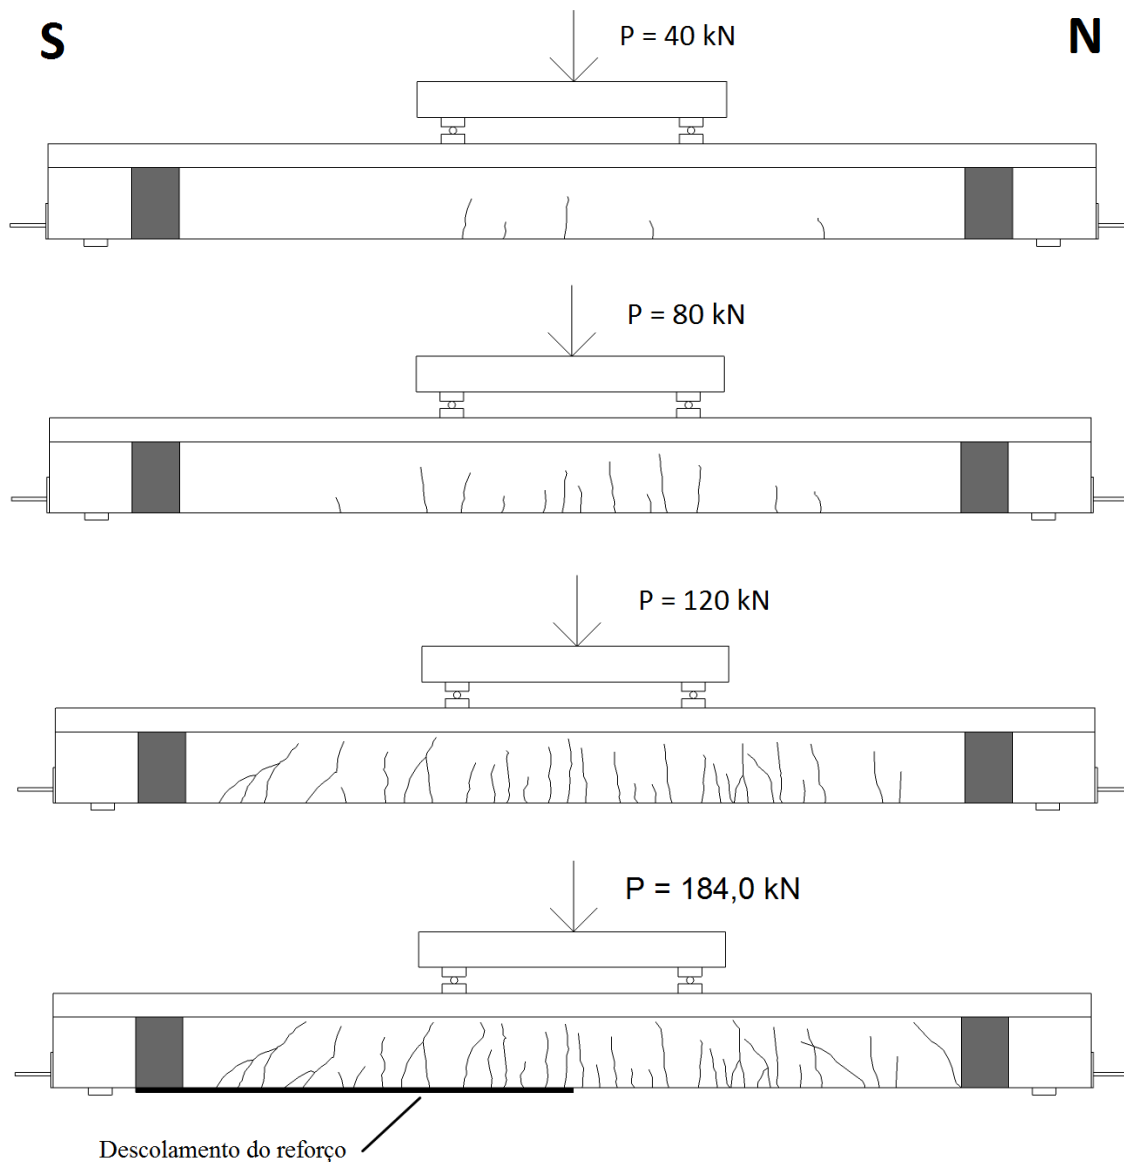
Evolução da fissuração na viga VA2 - CV
